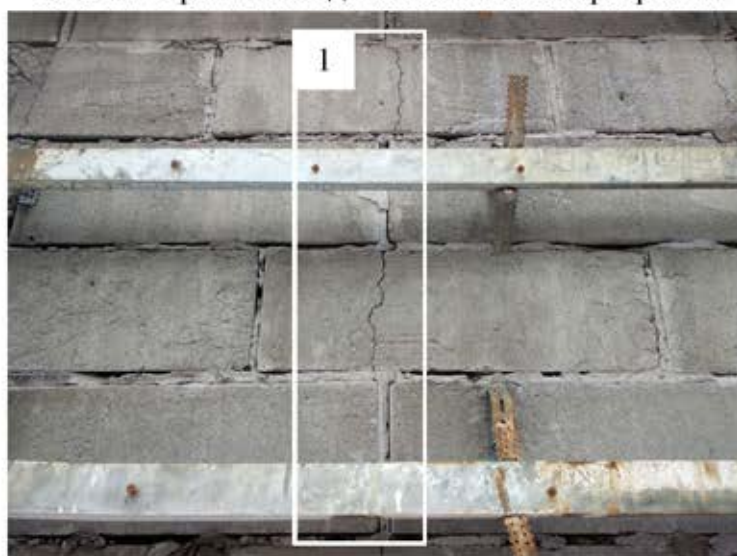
Фрагмент вида стены. Дефекты: 1-трещина в газобетонных блоках.
